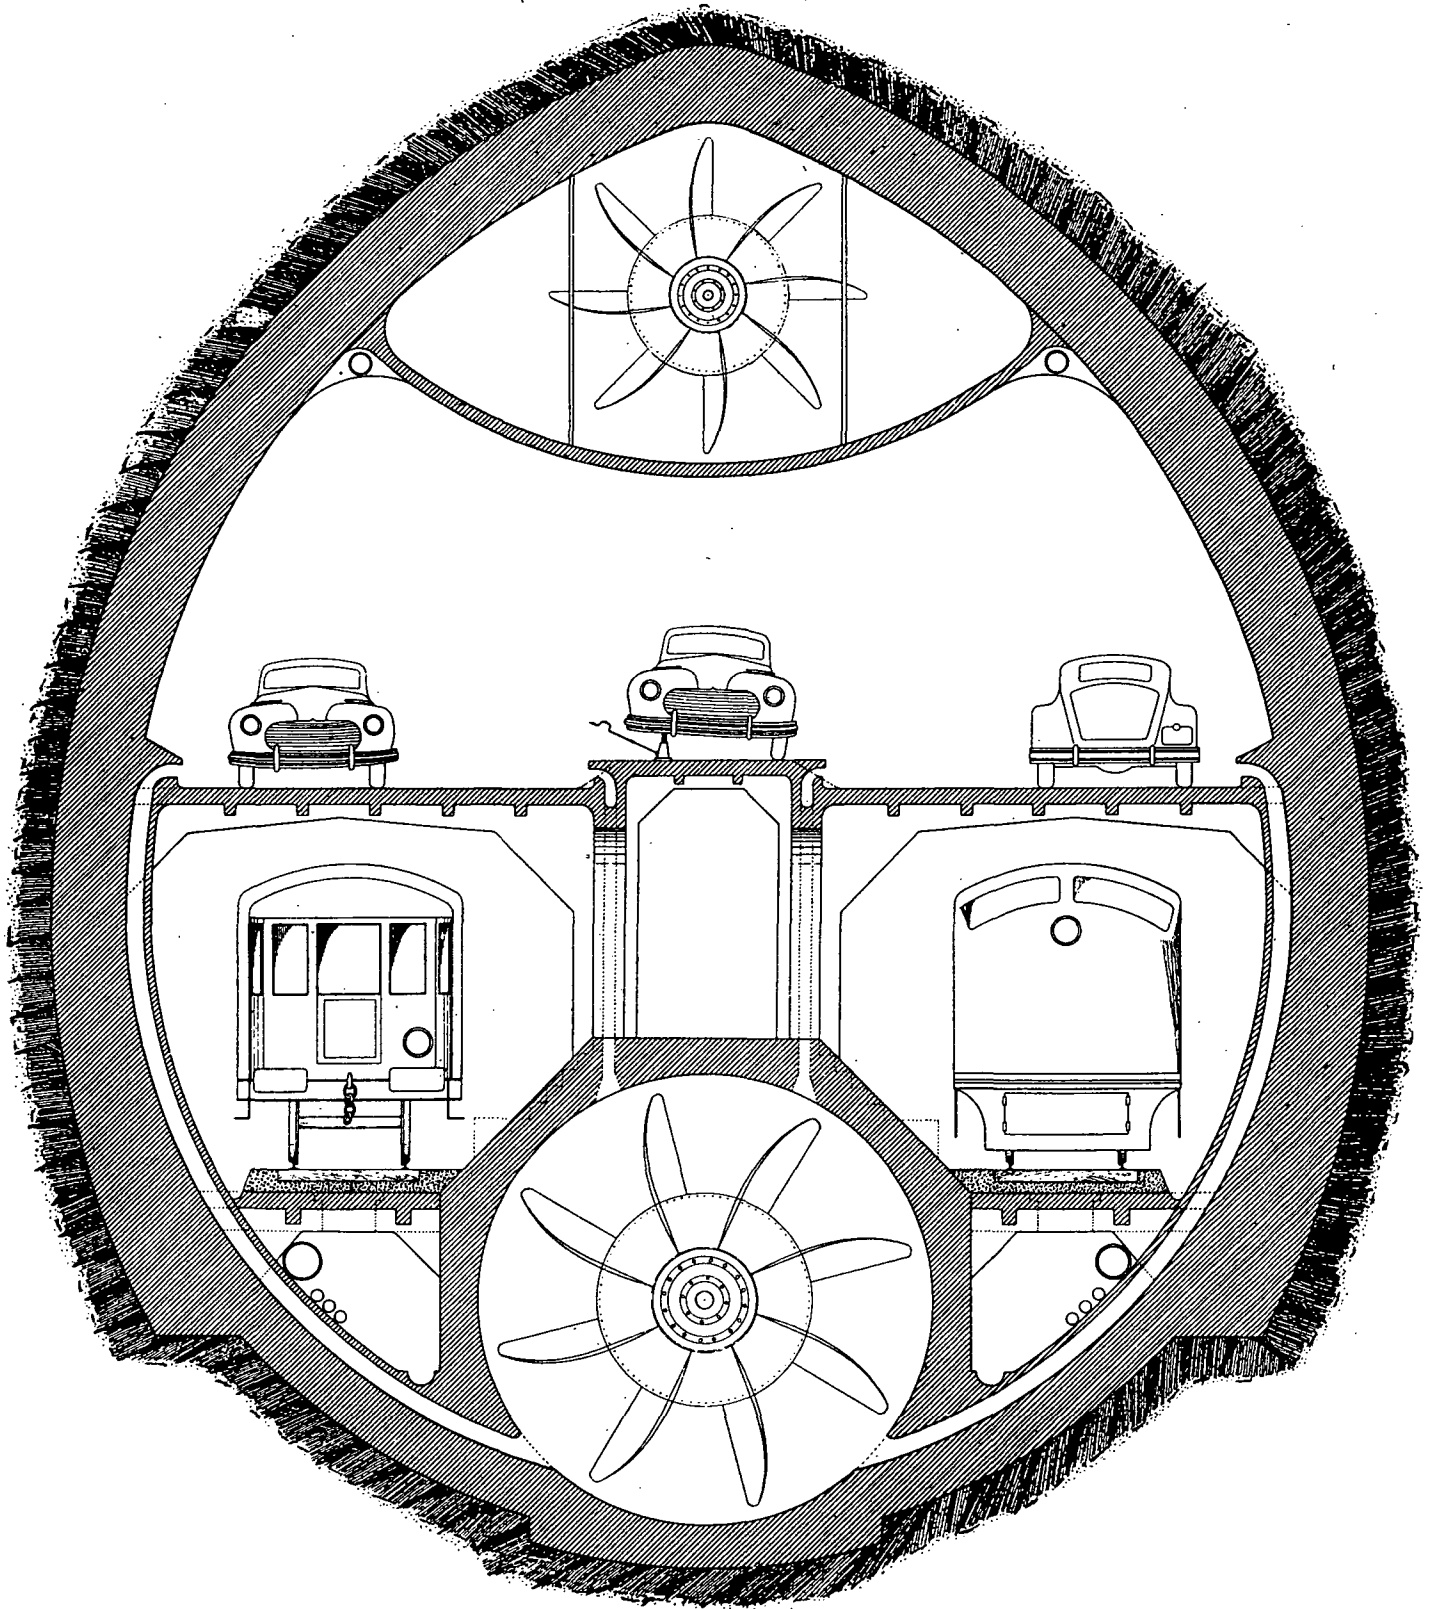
Coupe du tunnel mixte Basdevant 1948
